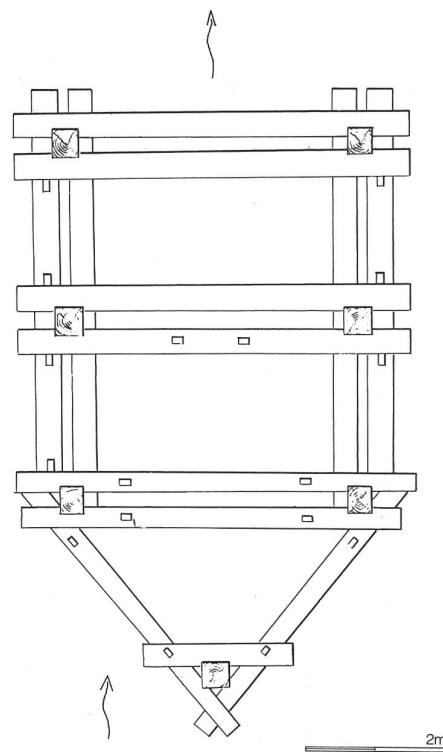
Laupen - Saanebrücke 1928. Detail aus dem Plan des Kreisgeometers A. Beyeler: «Sichtbarer Rost aus Eichenbalken des Jochs B» der mittelalterlichen Brücke (1395/96 n. Chr.) bei Laupen. →Flieissrichtung der Saane. M. 1:100.
